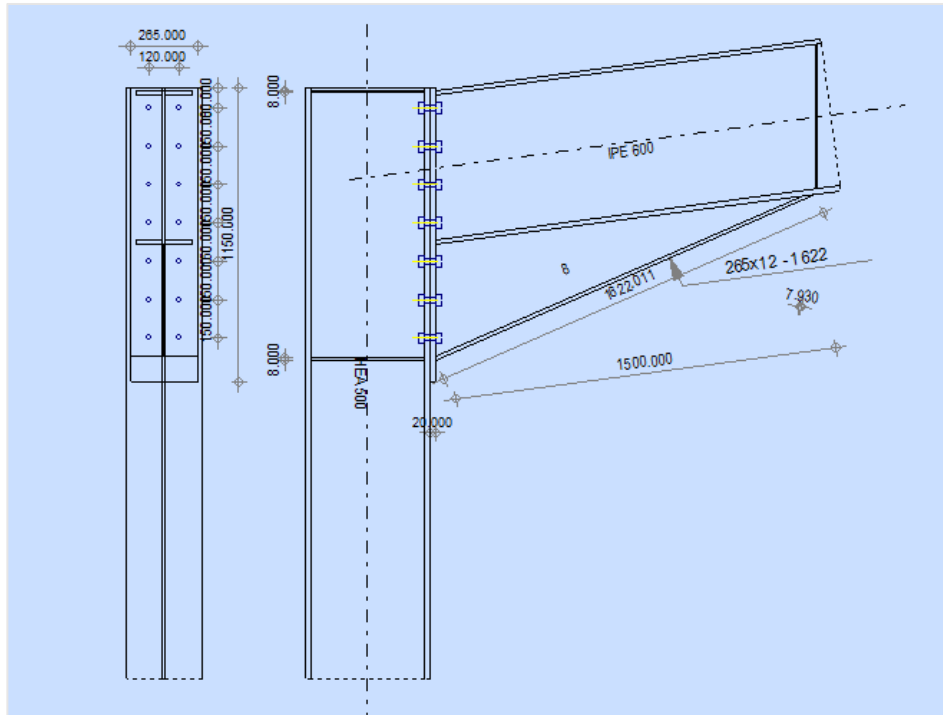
Détail de l'assemblage poteau-traverse (HEA 500–IPE 600)
